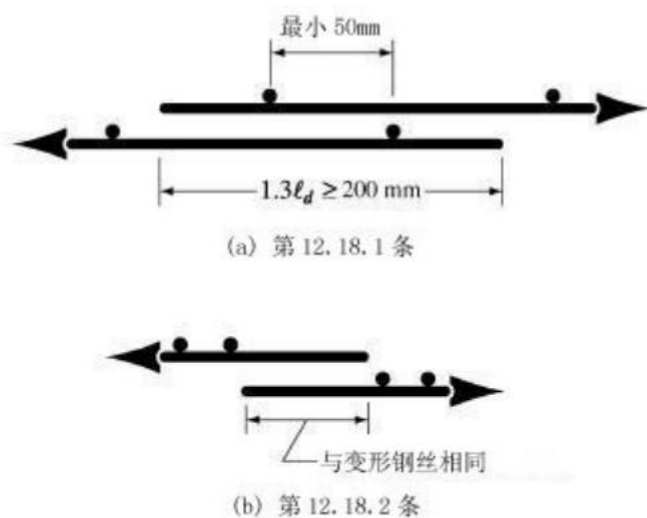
焊接变形钢丝网的搭接接头
